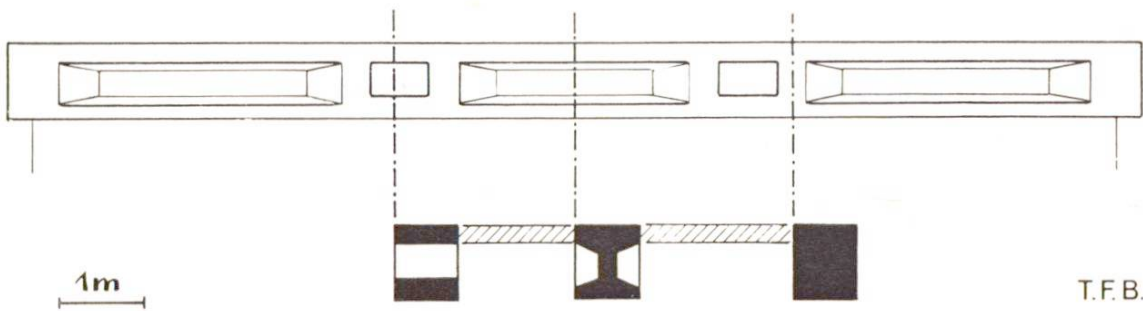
Vorfabrizierter Betonbalken für die Geschossdecken. Spannweite 13,8 m, Abstände 3,5 m. Zwei grosse Aussparungen für quergeführte Belüftungskanäle bedingen einen unregelmässigen Querschnitt.
